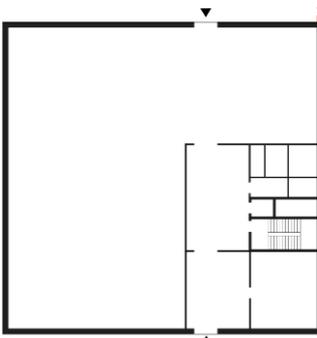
Vorentwurf Grundriss Erdgeschoss SGA
